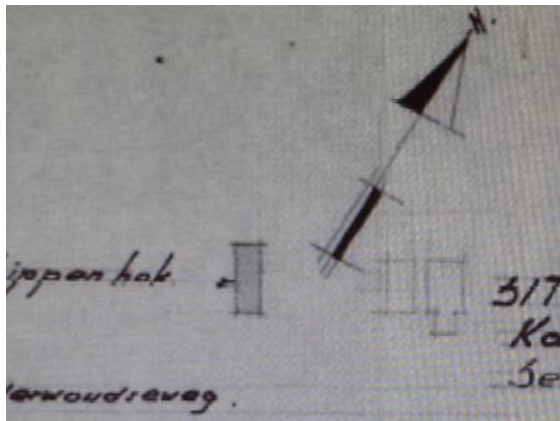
Ligging nieuw te bouwen kippenhok uit 1959
